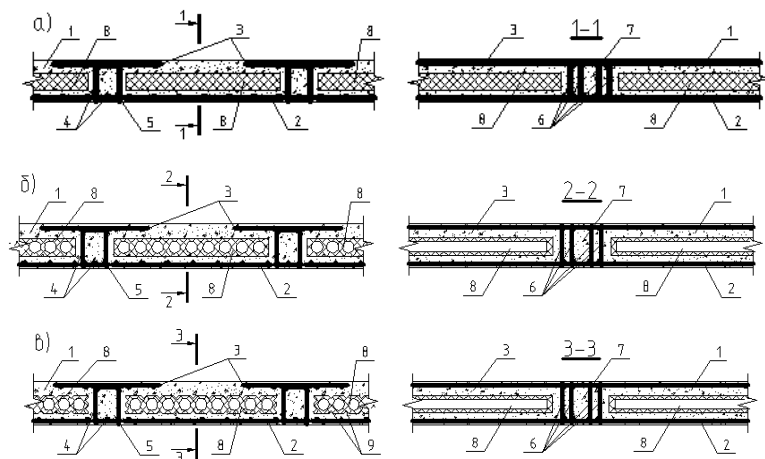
Сборно – монолитные железобетонные перекрытия: а) 1 – балочная плита; 2 – нижняя арматурная сетка балочной плиты; 3 – верхняя арматурная сетка балочной плиты; 4 – арматурные каркасы «условных» второстепенных балок; 5 – «условные» второстепенные балки; 6 – арматурные каркасы «условных» главных балок; 7 – «условные» главные балки; 8 – теплоизоляционные вкладыши; б) то же, но 8 – железобетонные вкладыши с пустотами; в) то же, но 8 – железобетонные вкладыши с пустотами; 9 – углубления во вкладышах по контактным поверхностям с монолитным бетоном
